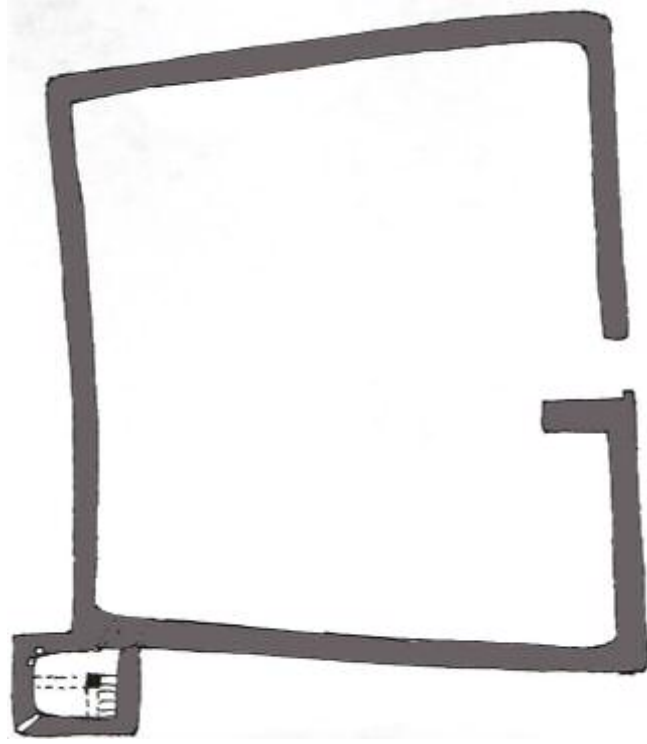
رسم يبيّن مسقط في برج وجزء من سور قصر بابا السعد
